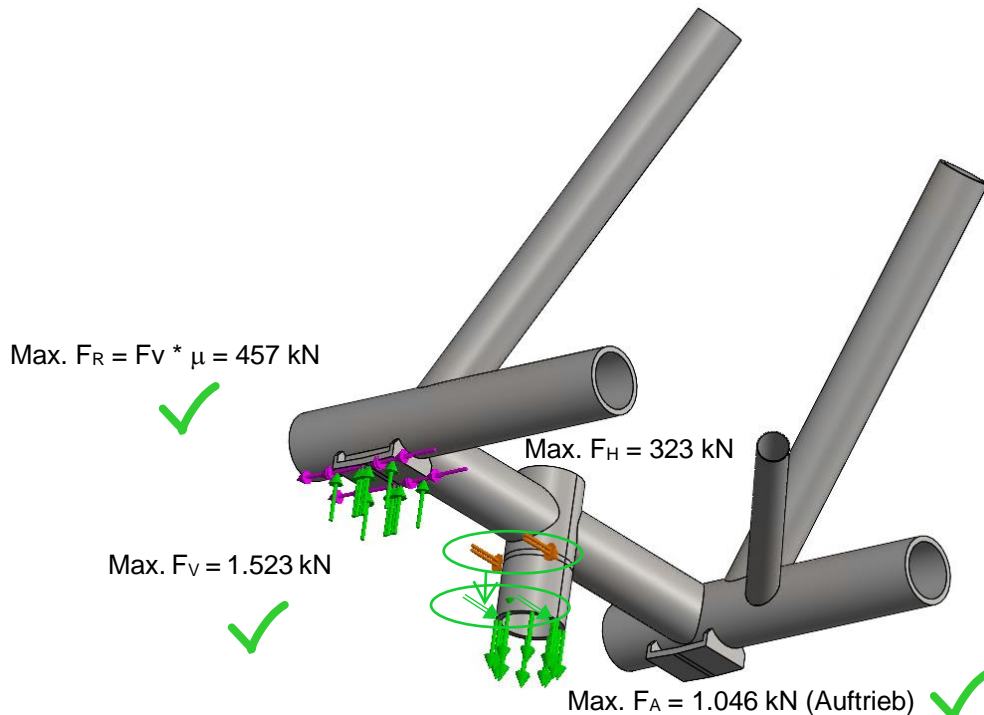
Lastaufbringung – Detailmodell der Brückenlager für Brücke B4
